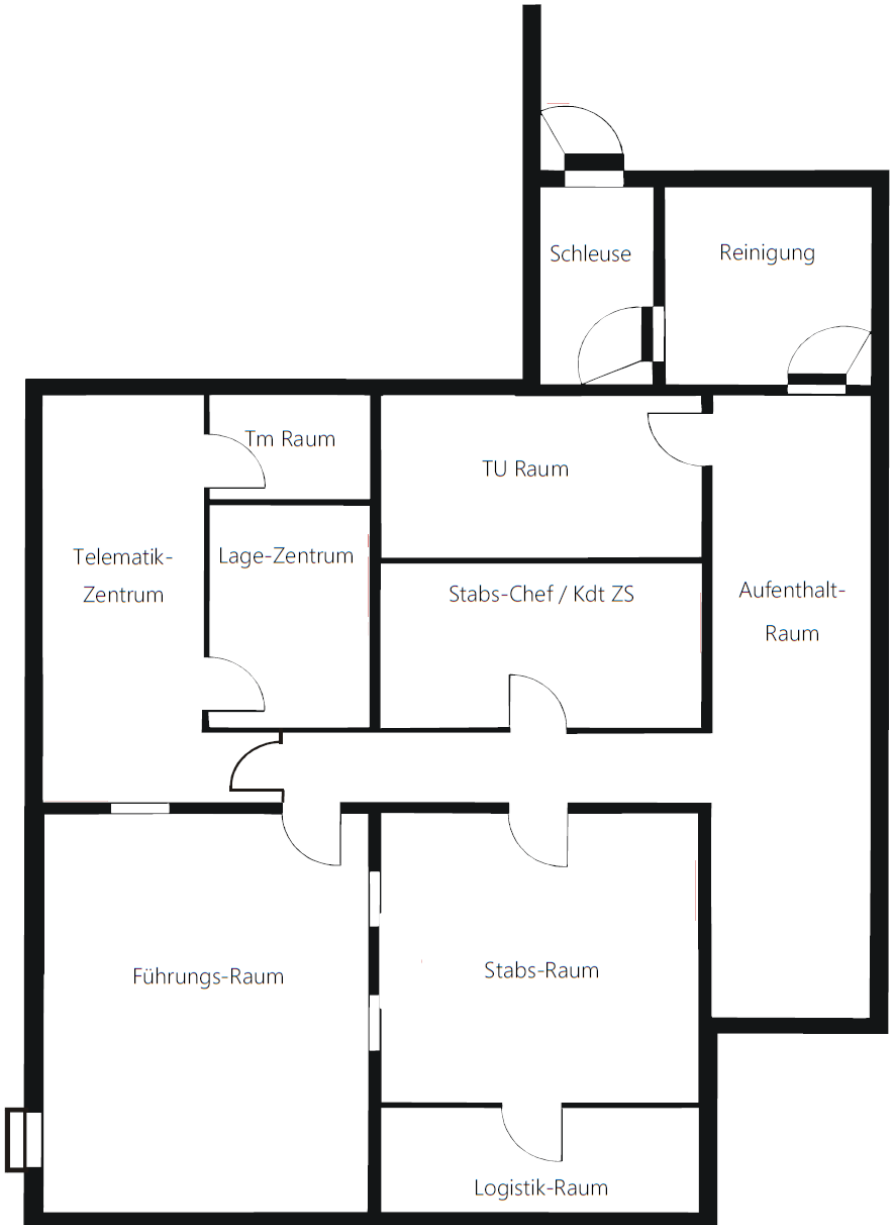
Grundriss Kommandoposten Typ II.
